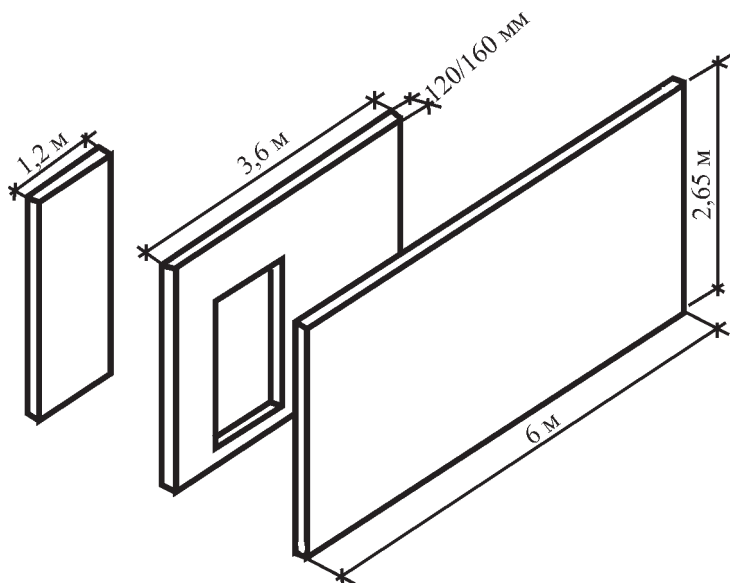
Панели наружных и внутренних стен жилых зданий
